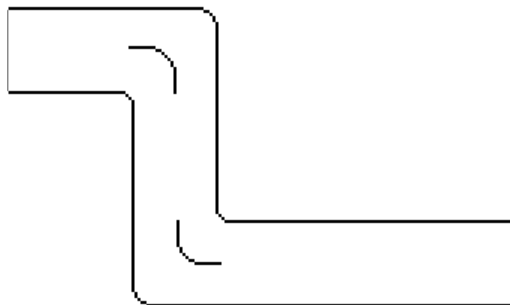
Конструкции двойного поворота с направляющими лопатками
